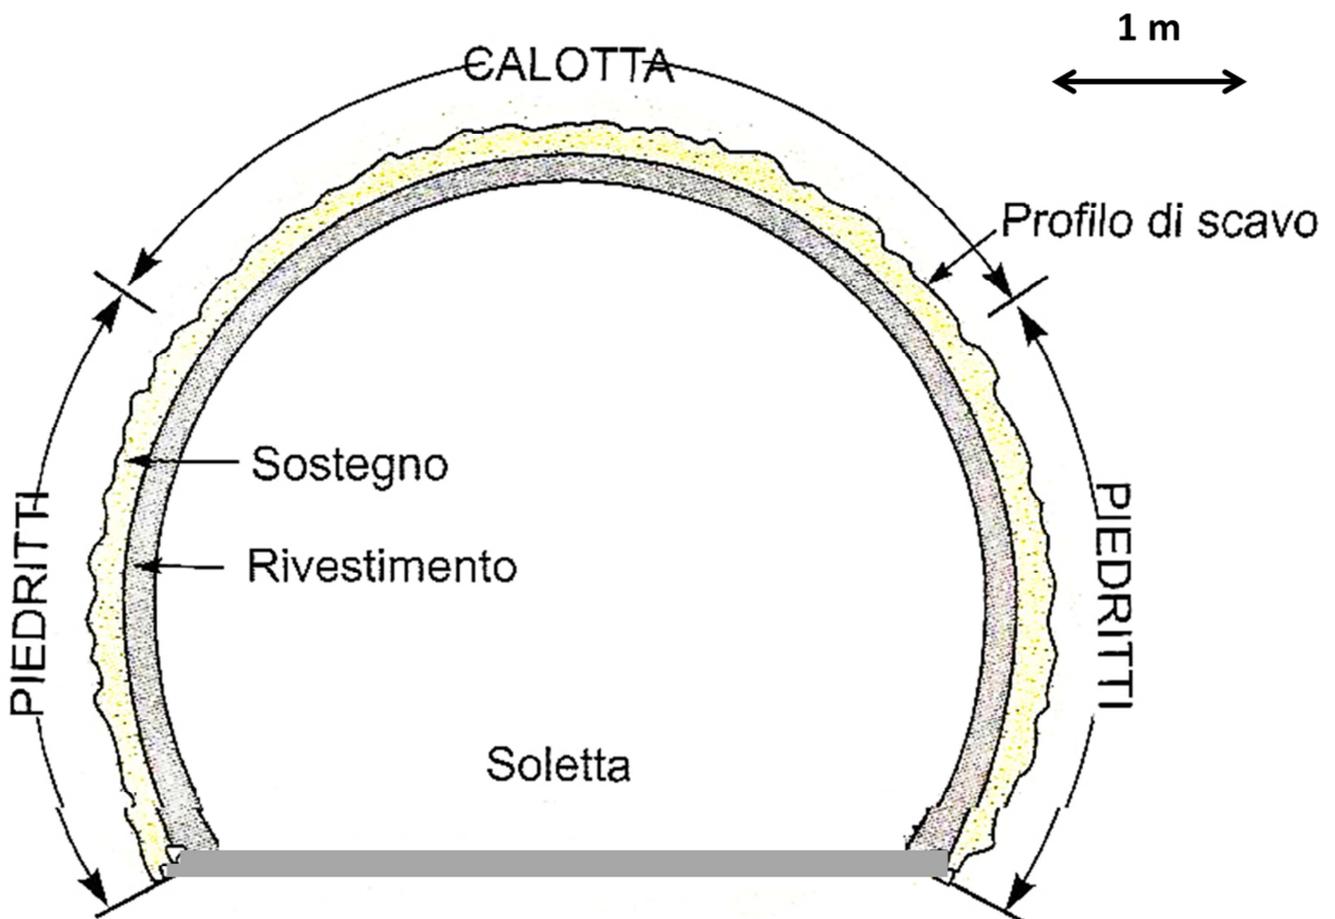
Schema della sezione di scavo e sezione utile della galleria
